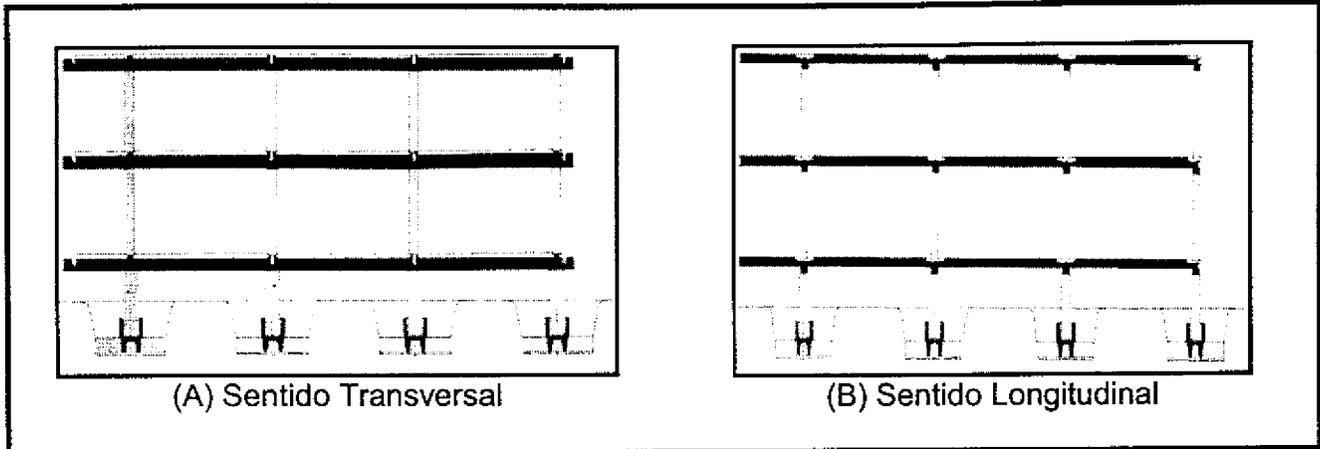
Esquema estructural del Sistema Constructivo Girón.
